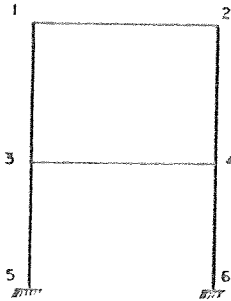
Numeração dos nós de um pórtico plano retangular com 2 andares.
